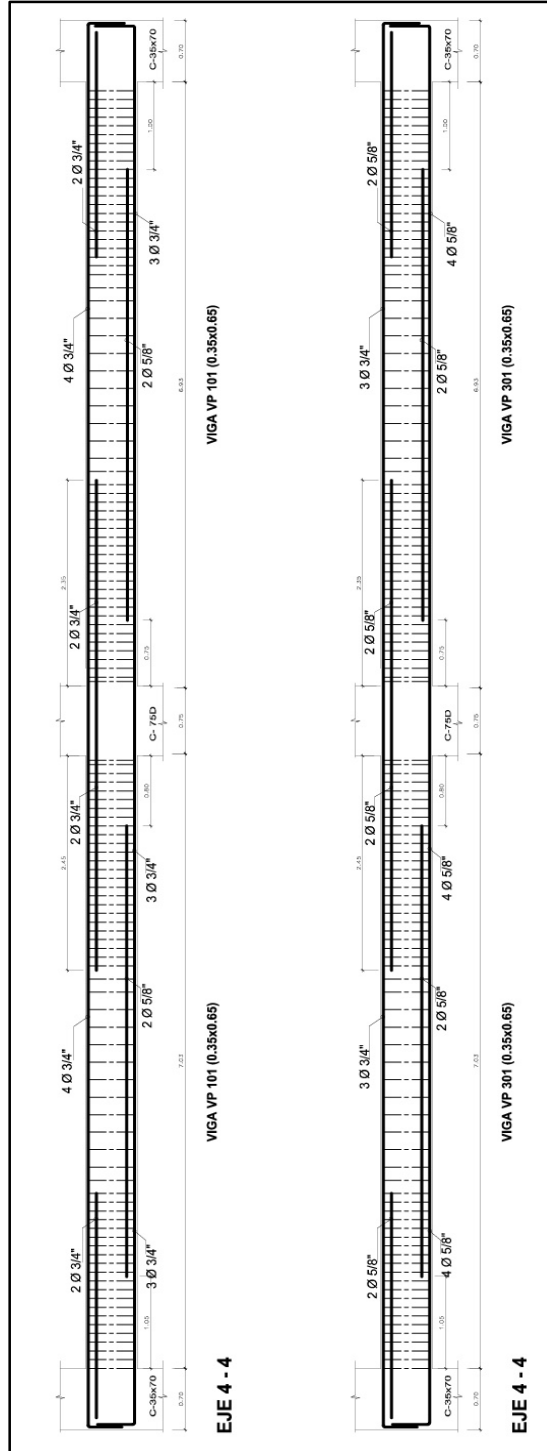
Acero longitudinal en vigas del eje 4- 4 del primer y tercer nivel.
